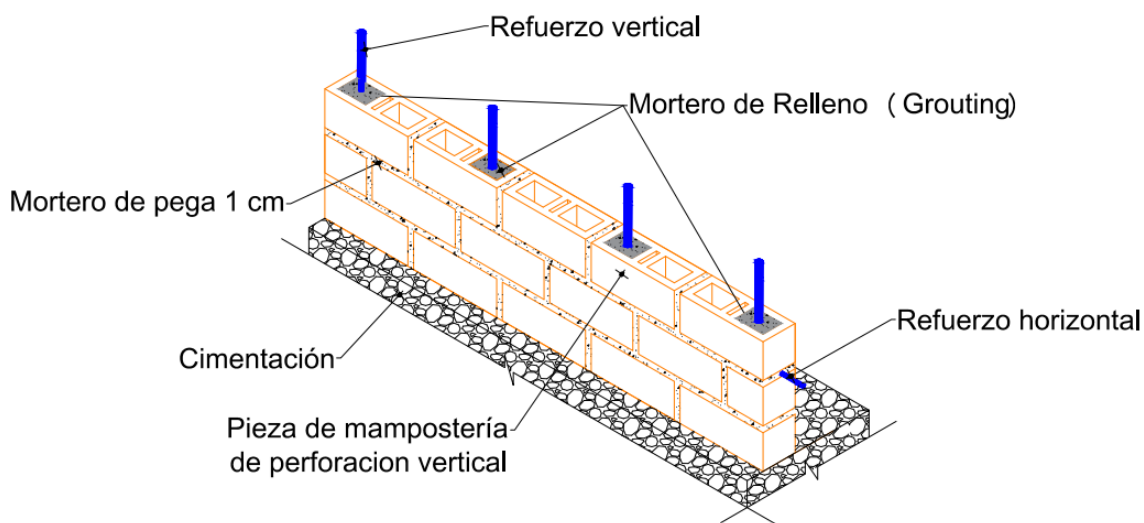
Mampostería reforzada (planta). fuente (Elaboración propia)
